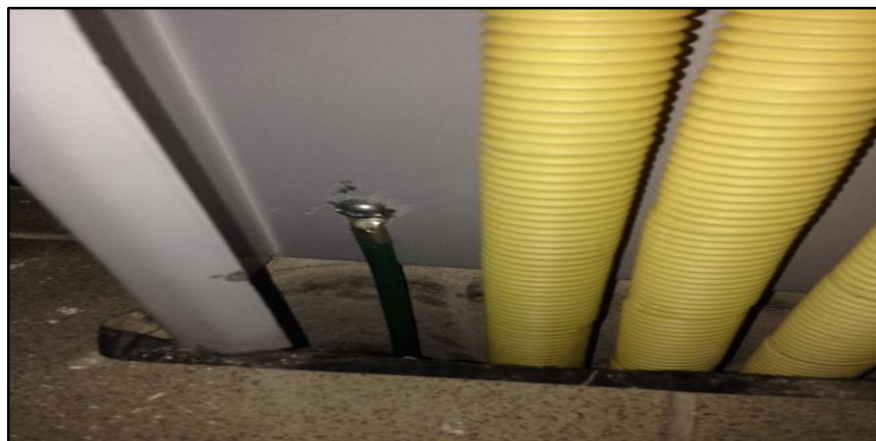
Conexión de canaletas metálicas al sistema de tierra
